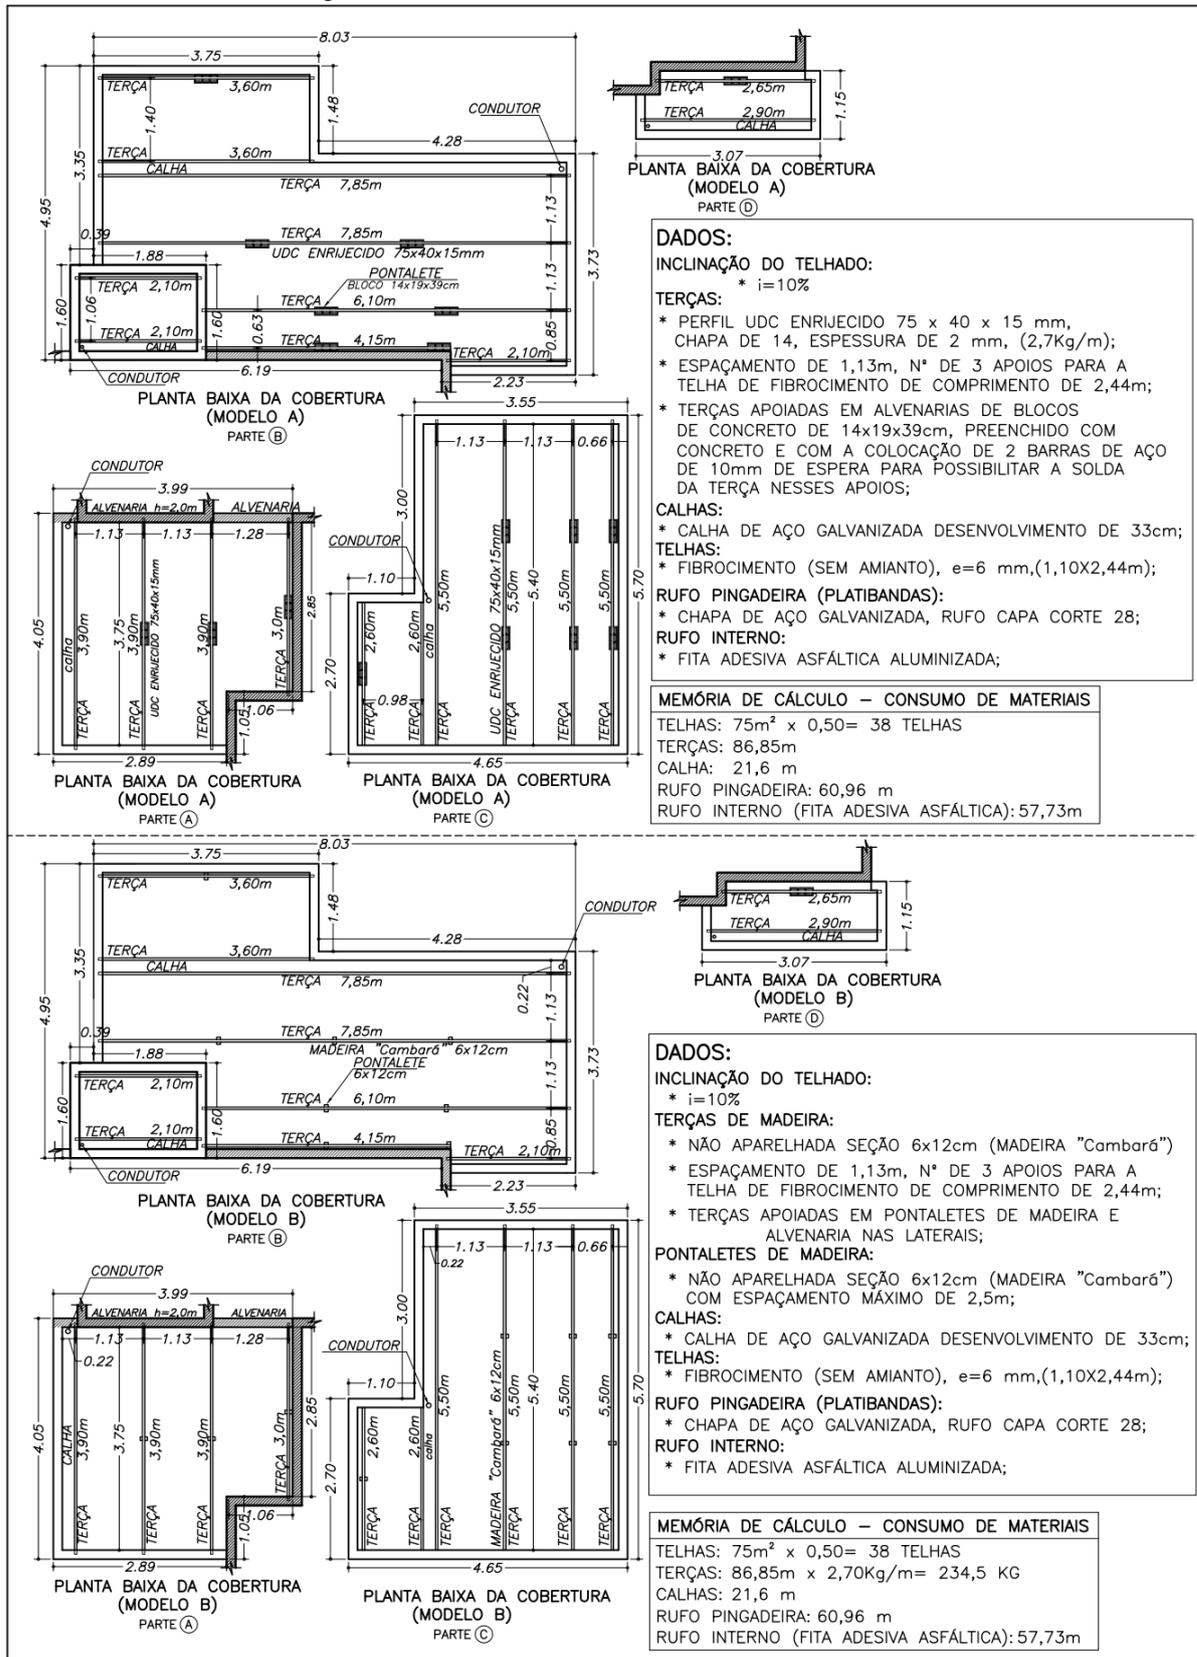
Planta baixa e desenhos da edificação objeto de estudo.
